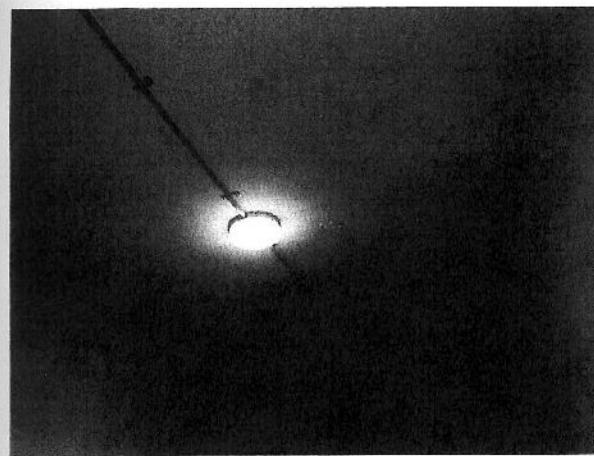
Освещение лифтовой площадки корп. 605 – сеть освещения проведена открытым способом в ПВХ трубах, светильники установлены светодиодные без датчиков присутствия, на аварийной группе весит один из трех светильников
